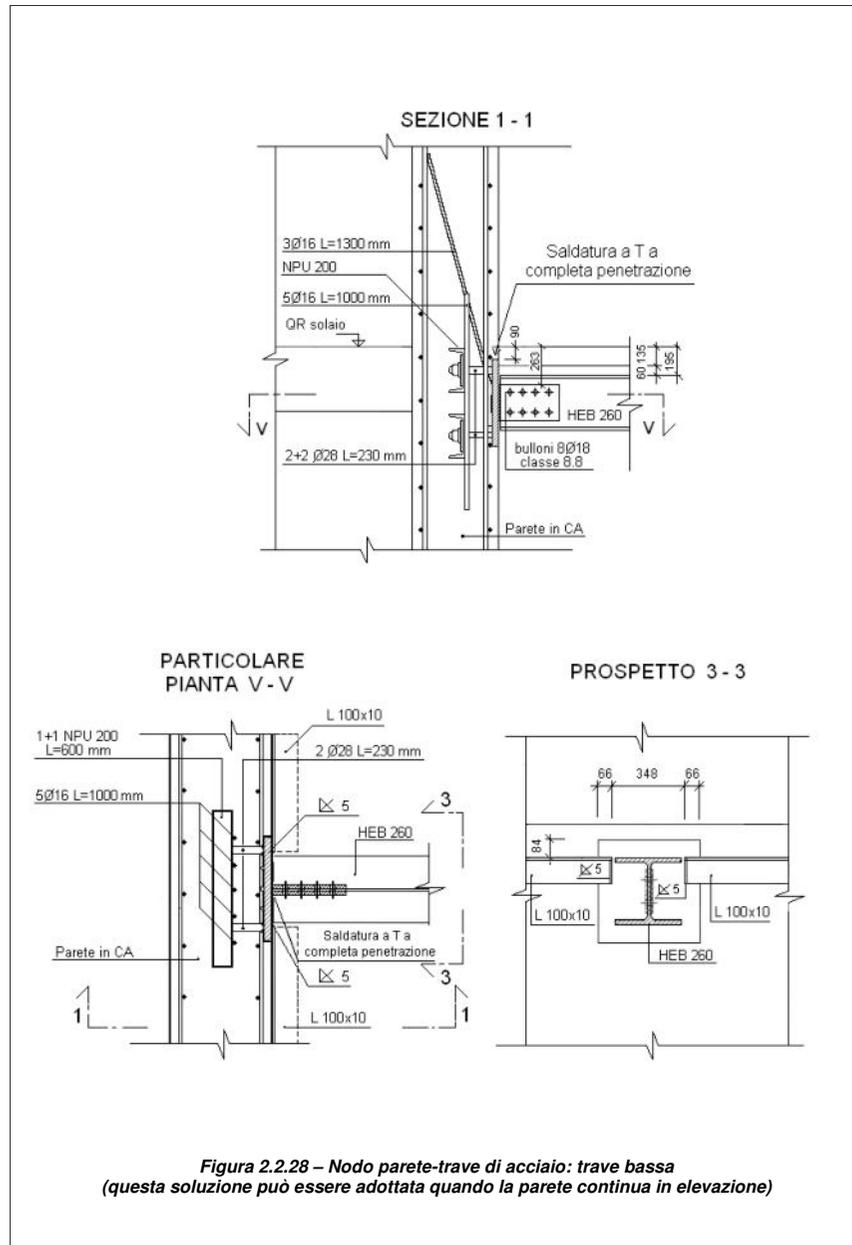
Nodo parete-trave di acciaio: trave bassa
